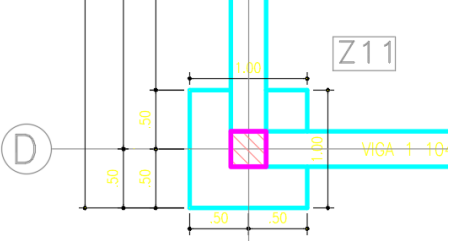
Detalle de zapatas	Foto 28 Zapata Z11
